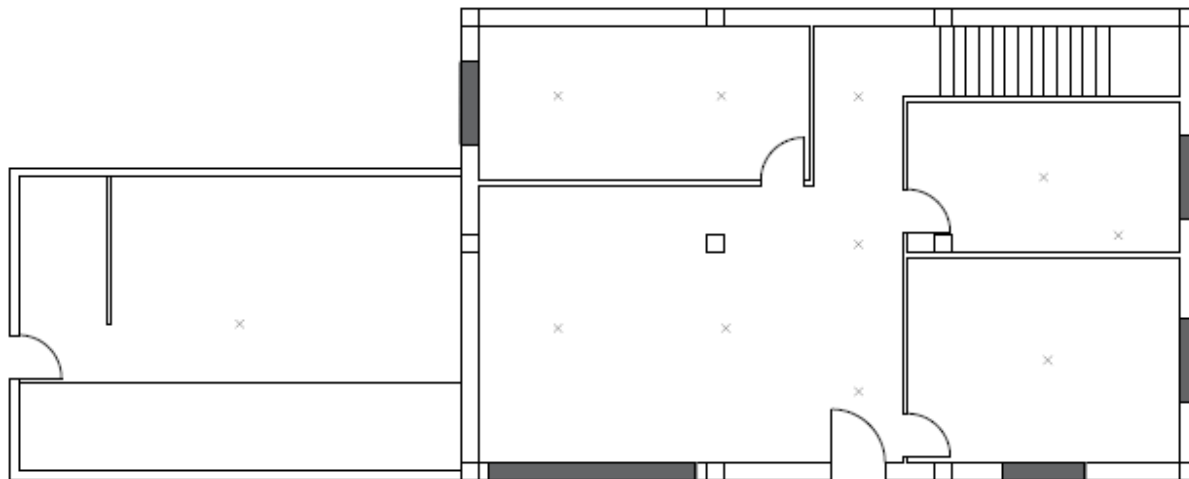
Plano Iluminación de la Vivienda Mejorada planta baja.
